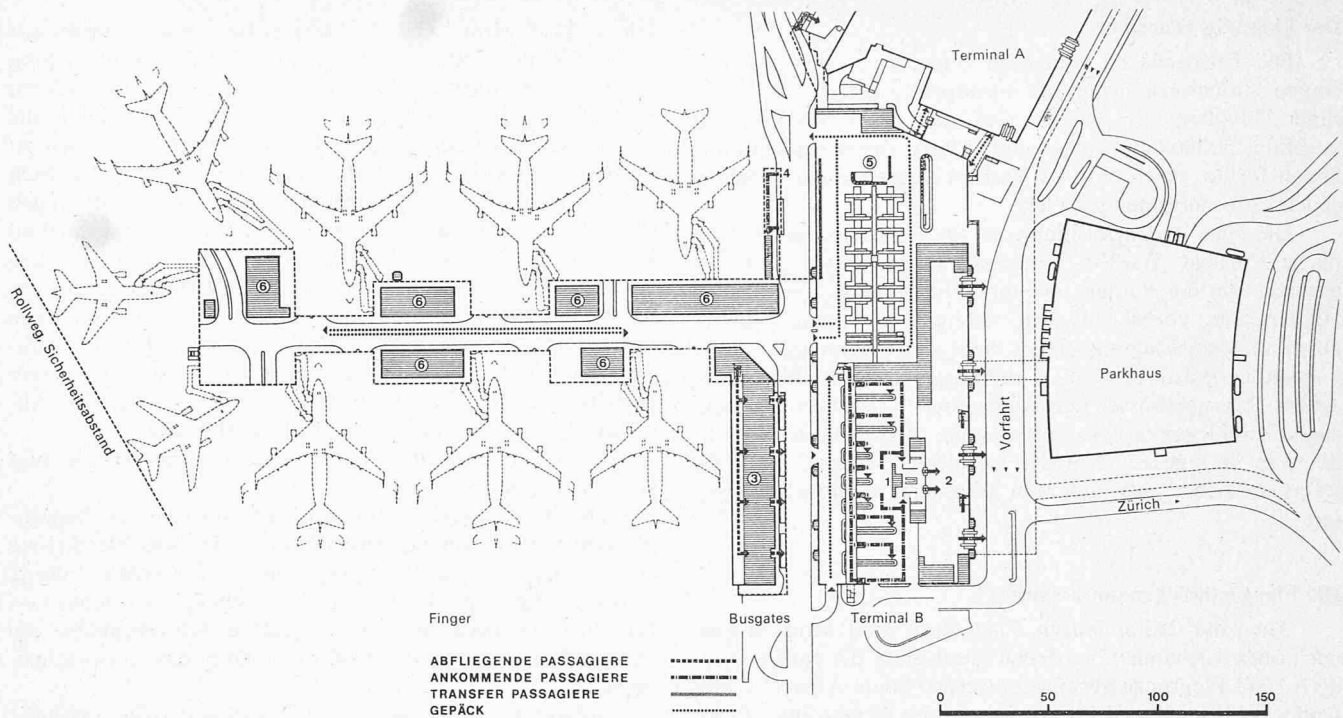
Terminal B. Transitgeschoss, Grundriss. 1 Gateraum; 2 Passkontrolle; 3 Transitschalter; 4 «Air Side Corridor»; 5 Transit Lounge; 6 Transit-Restaurant; 7 Gepäcksortierung
